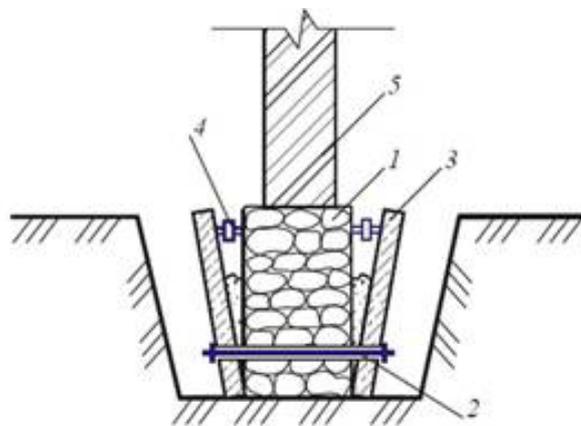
Усиление монолитного ленточного фундамента уширением основания с использованием железобетонных отливов: 1 – фундамент; 2 – стальной тяж; 3 – железобетонный отлив; 4 – домкрат; 5 – стена
